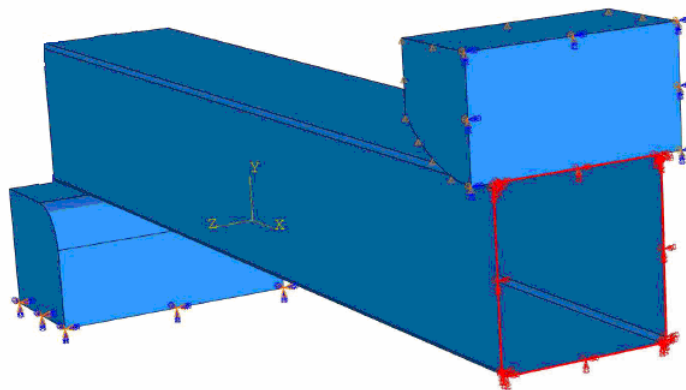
Restricción debida a la simetría aplicada a la mitad de la viga
